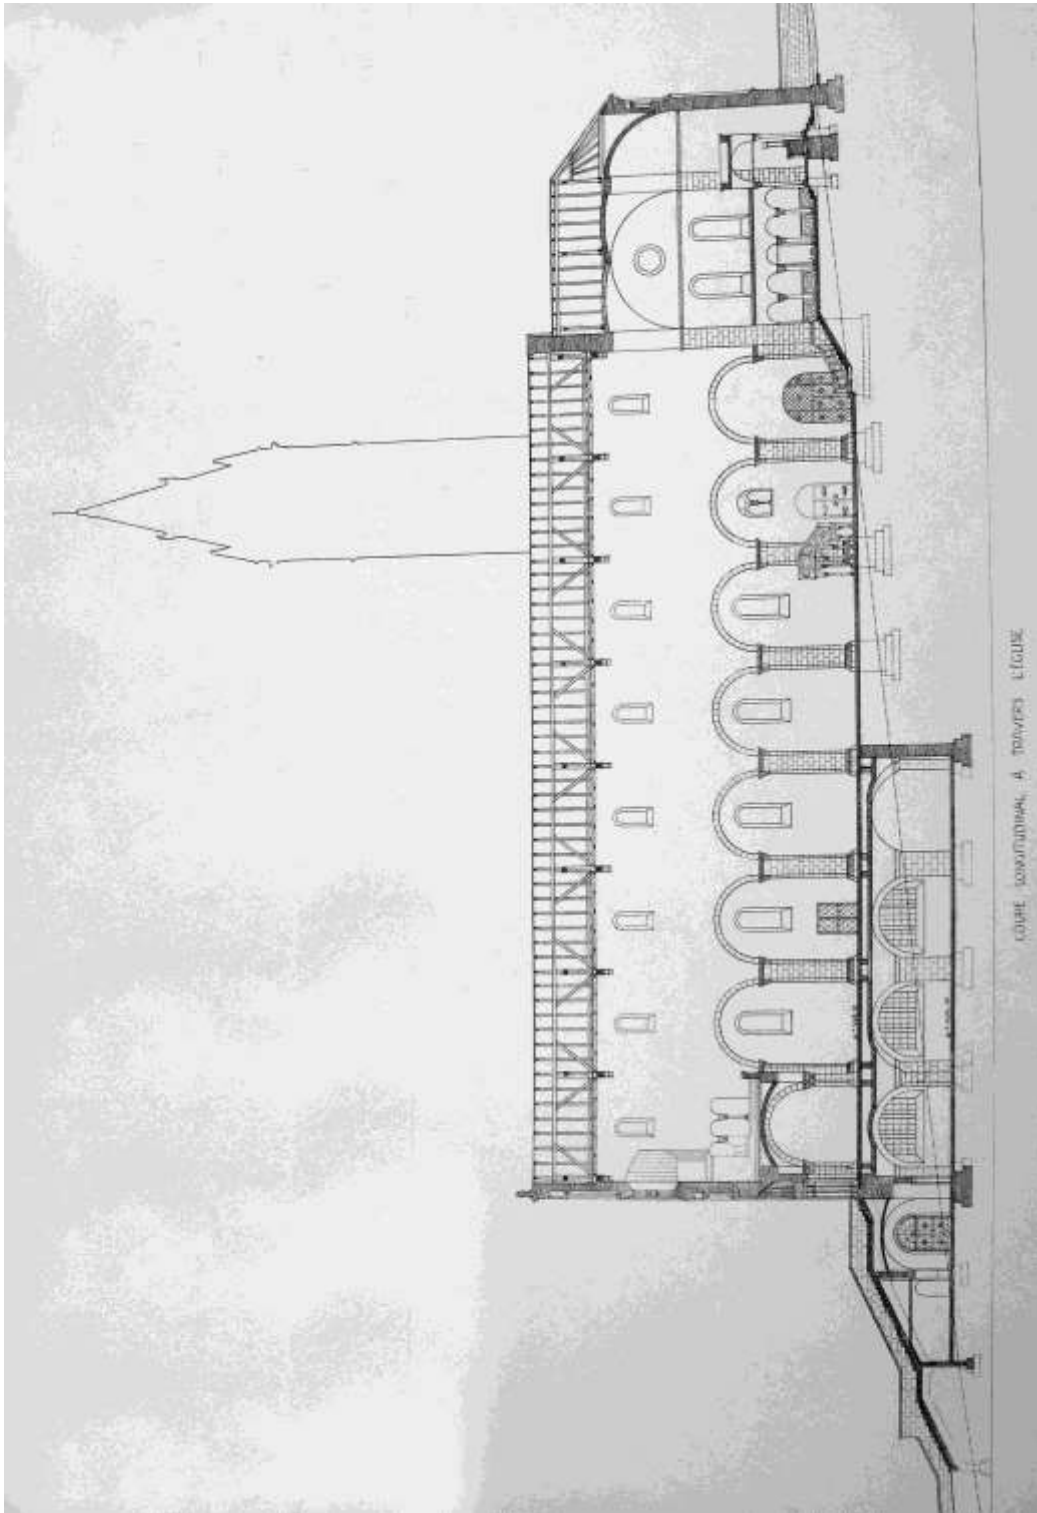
Plans d'exécution, coupe longitudinale, Otto Schmid et Willy Meyer architectes, 1915 (ACV PP 4/5).
